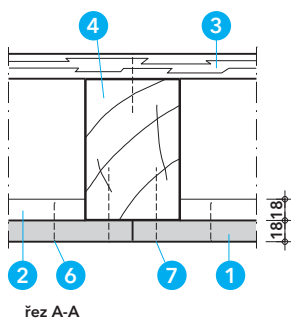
Detail J - varianta s viditelnými dřevěnými trámy - REI 30
